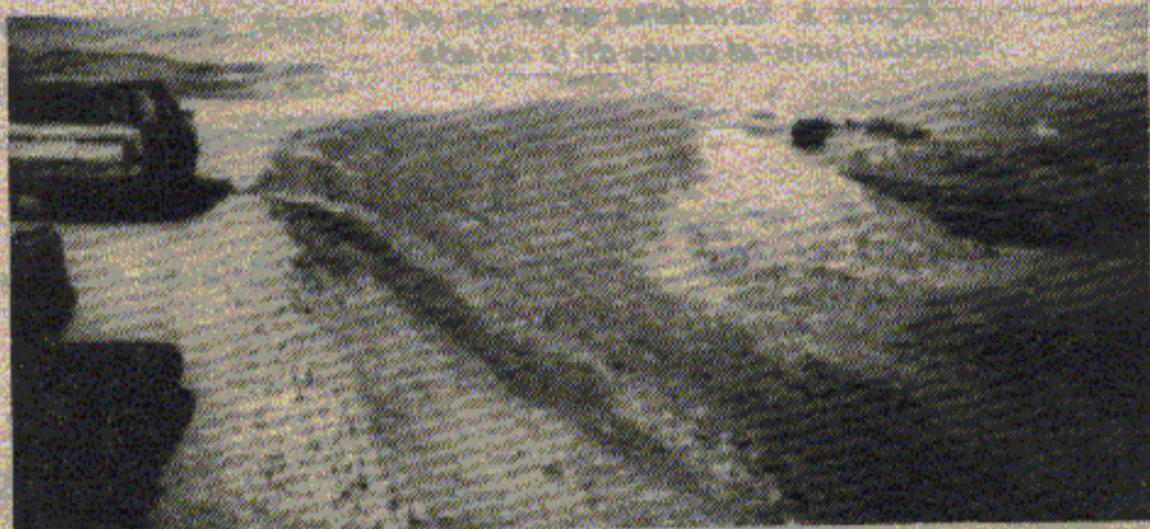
Presa construida con equipo vial, con talud trasero cubierto por tierra orgánica y coronamiento con adecuado balasto para el tránsito vehicular.
